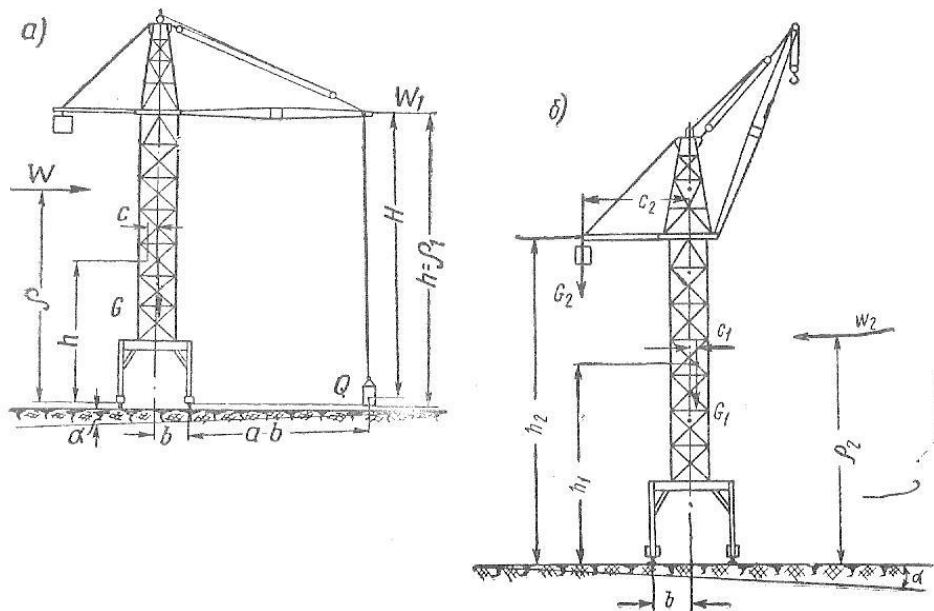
К расчету устойчивости башенного крана КБ-405-2
